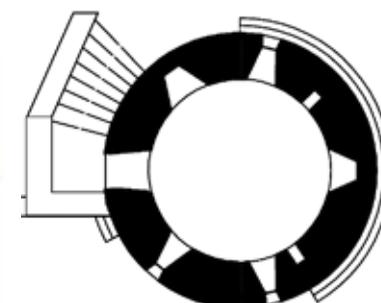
Grundriss Bad St. Leonhard, M 1:200.
